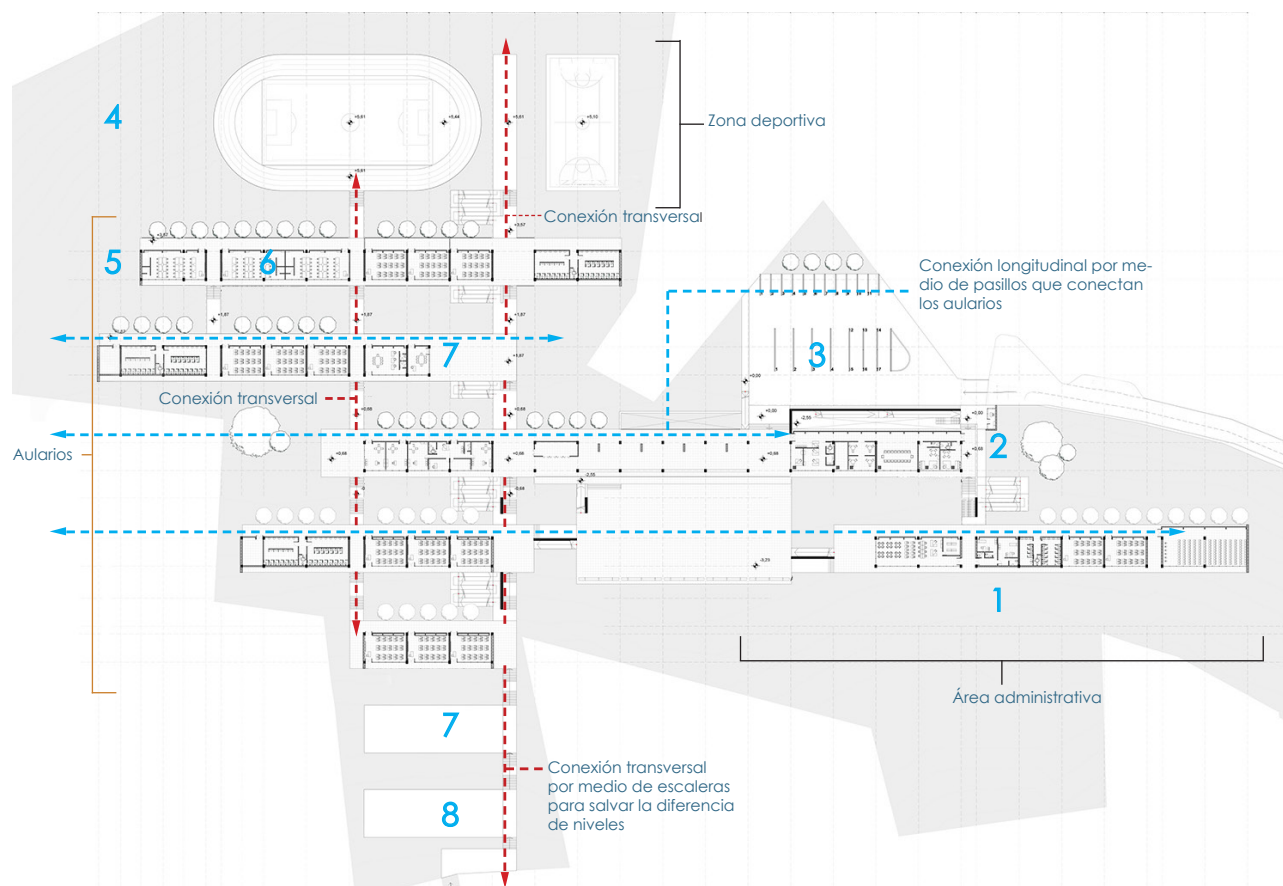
Planta arquitectónica. Fuente: blogfundamentos.
